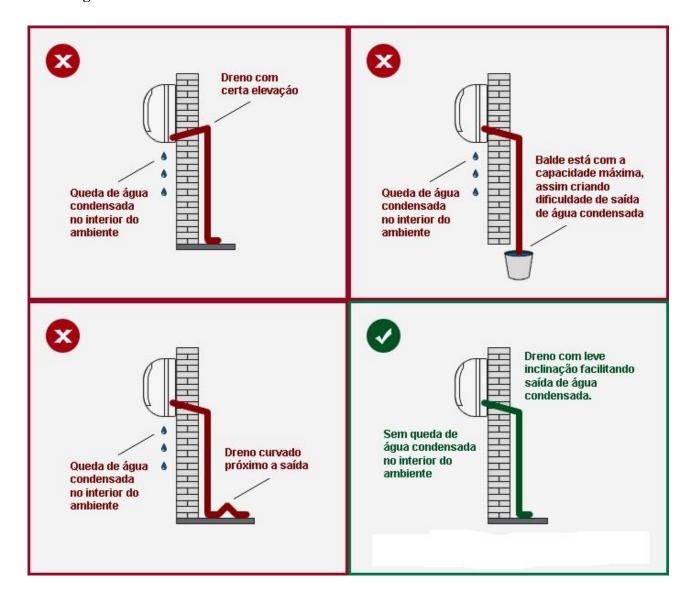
Guia de Instalação do Dreno para aparelhos do tipo Split.
